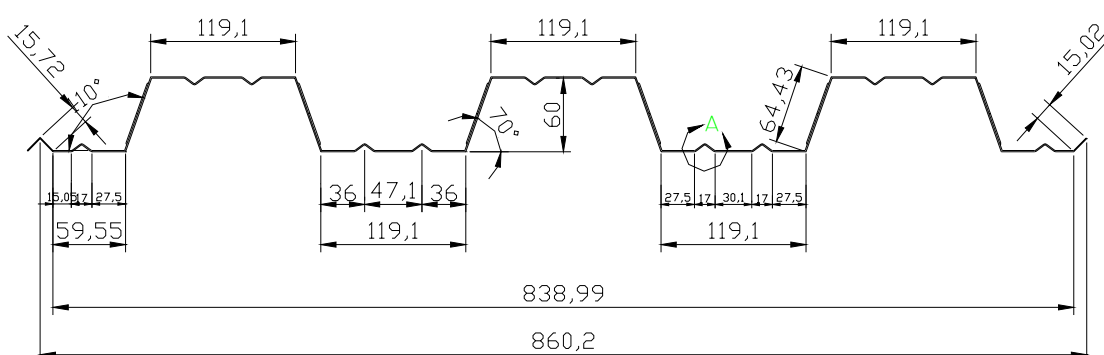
Seção transversal típica do perfil do DECK 60
